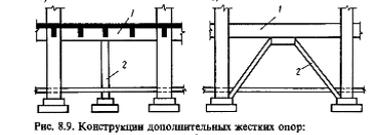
Конструкции дополнительных жестких опор: а – подведенная одиночная опора; б – подведенные подкосные опоры
